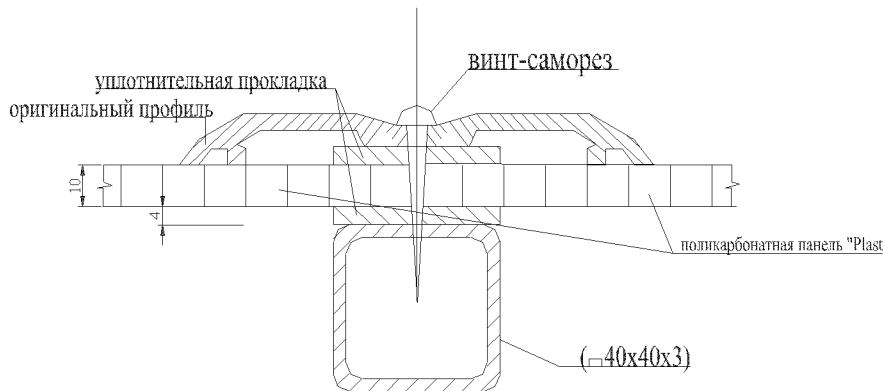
Узел крепления светопрозрачных ограждающих панелей к несущим конструкциям навеса внутреннего дворика.
